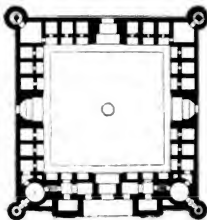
Grundriß der Medresse Schur-dar in Samarkand (nach Allgem. Bauzeitung 1908).
